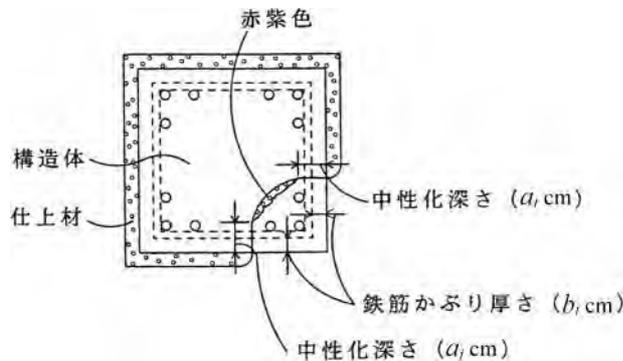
中性化深さ及び鉄筋かぶり厚さの測定方法
